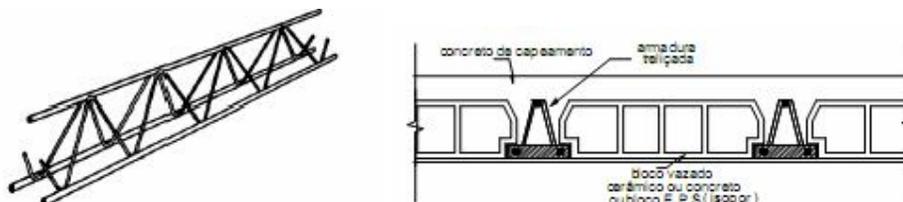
Perspectiva esquemática da armadura treliçada usada em lajes pré-fabricadas e seção transversal após o preenchimento de concreto da laje pré-fabricada com nervura do tipo treliça. Fonte: CARVALHO *et al.* (2005).
